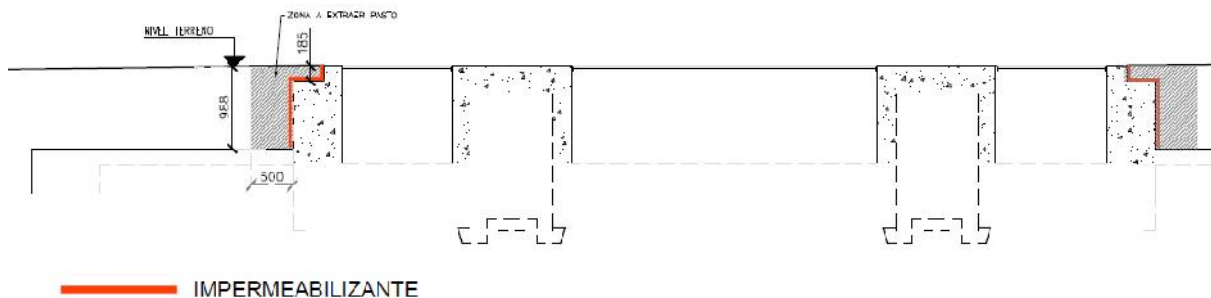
Corte Lucarna. Zona perimetral a impermeabilizar
